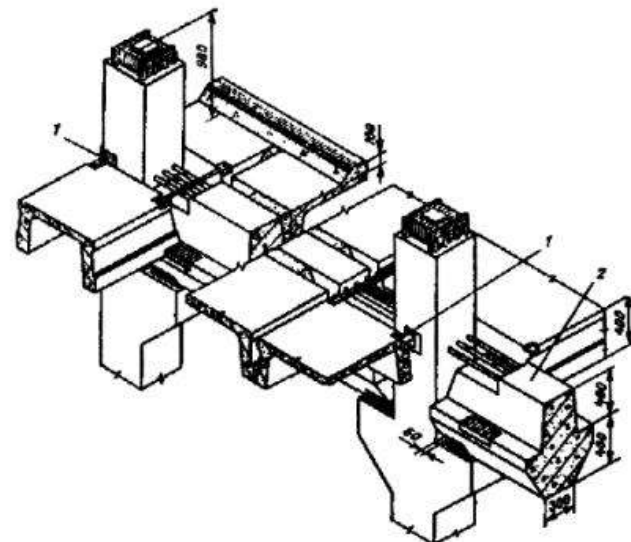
Соединение арматуры крайних плит перекрытия с арматурой колонн:
